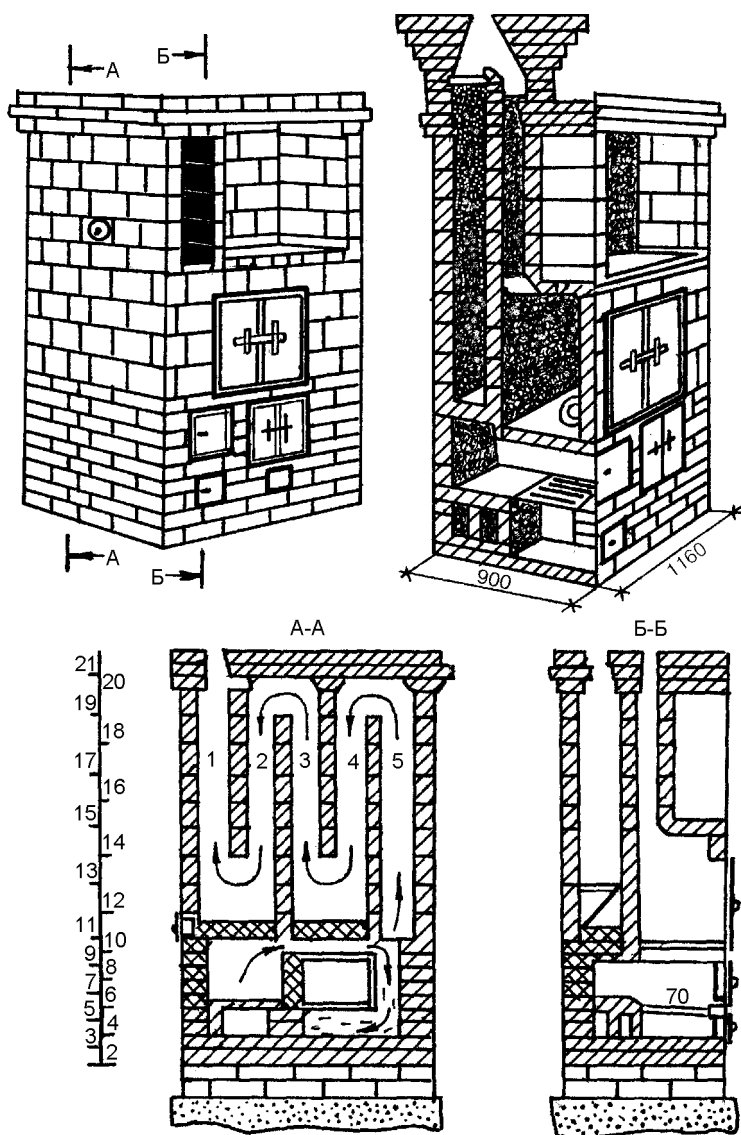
Устройство отопительно-варочной печи «Шведка»
